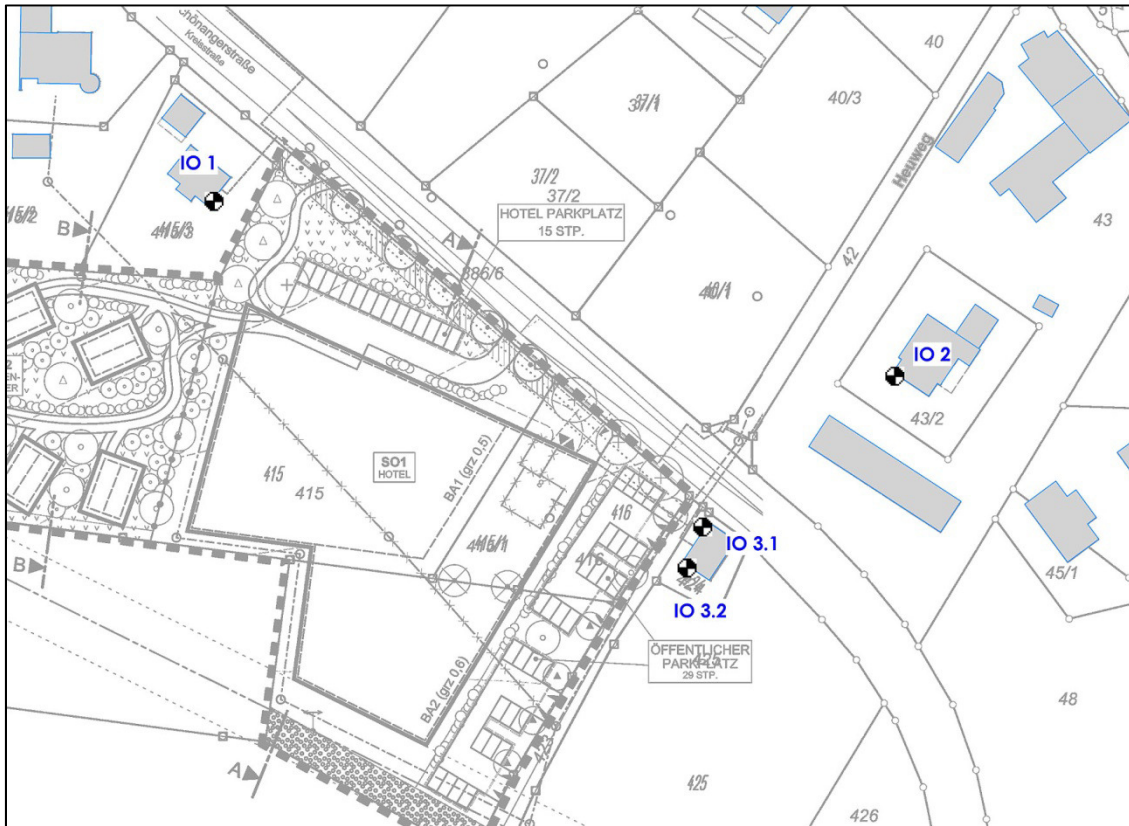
Lageplan mit Darstellung der maßgeblichen Immissionsorte in der Nachbarschaft
